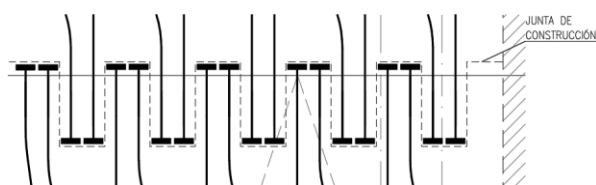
Detalle de junta dentada con anclajes pasivos de bloque alternados.
